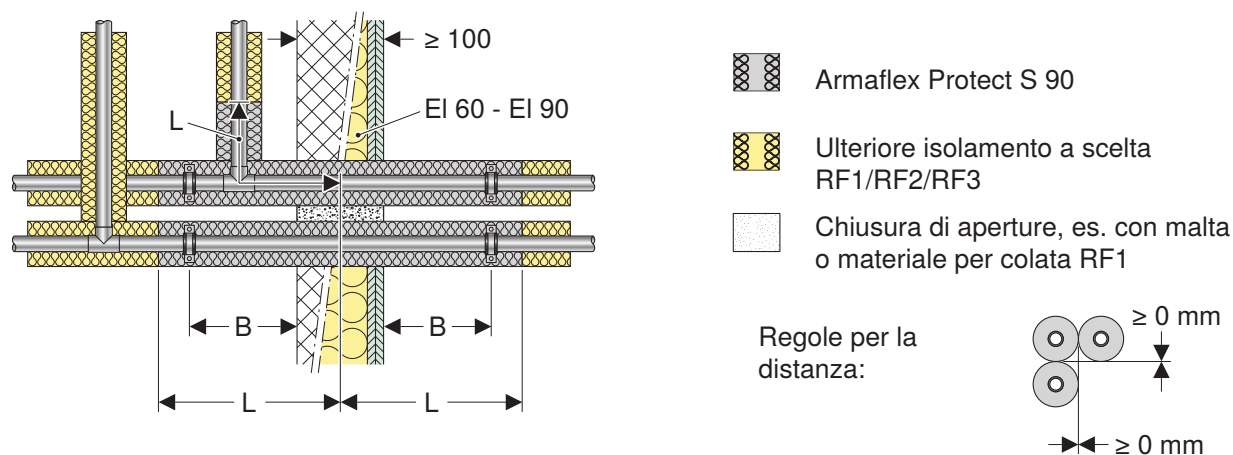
Passaggio per tubi in parete in muratura o parete leggera con Geberit Mapress e isolamento Armaflex Protect
